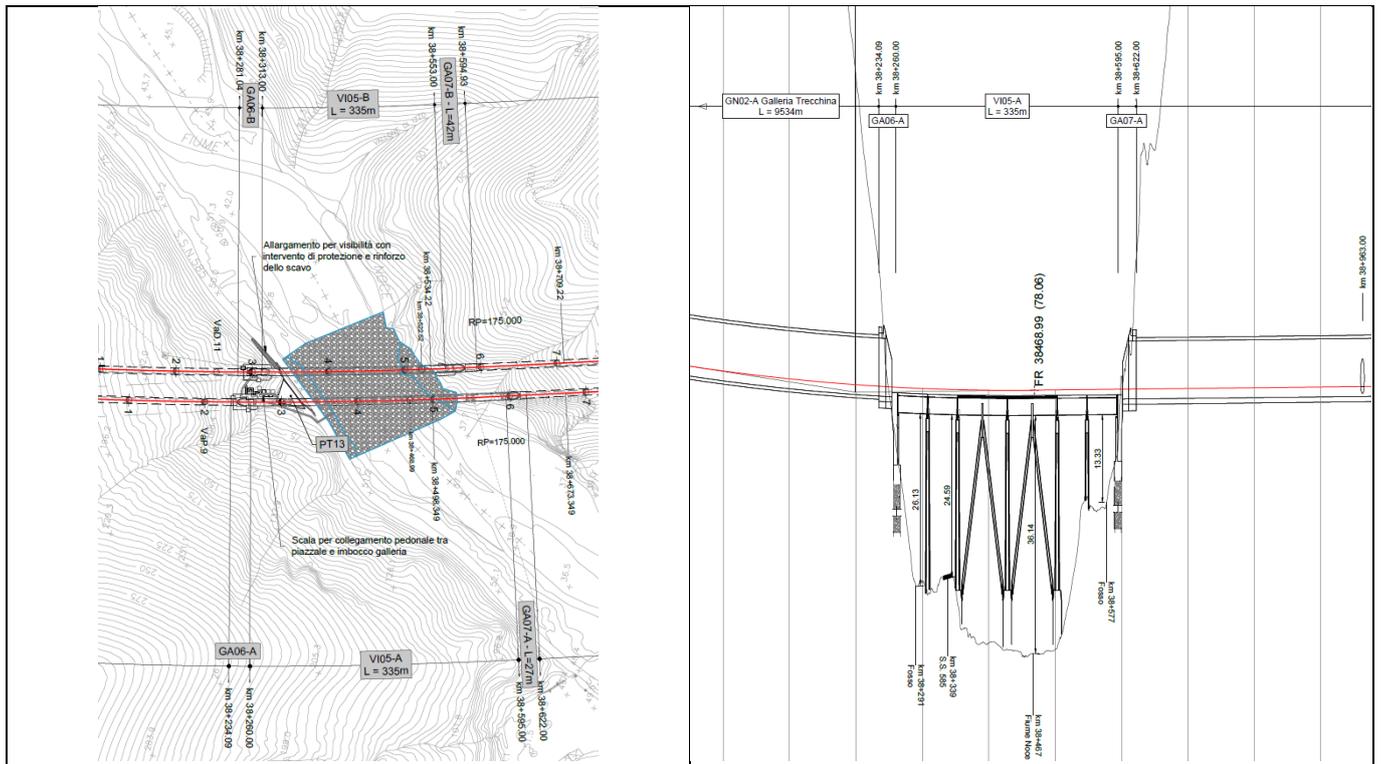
Planimetria e profilo di progetto VI05 da km 38+260 al km 38+595 BP
